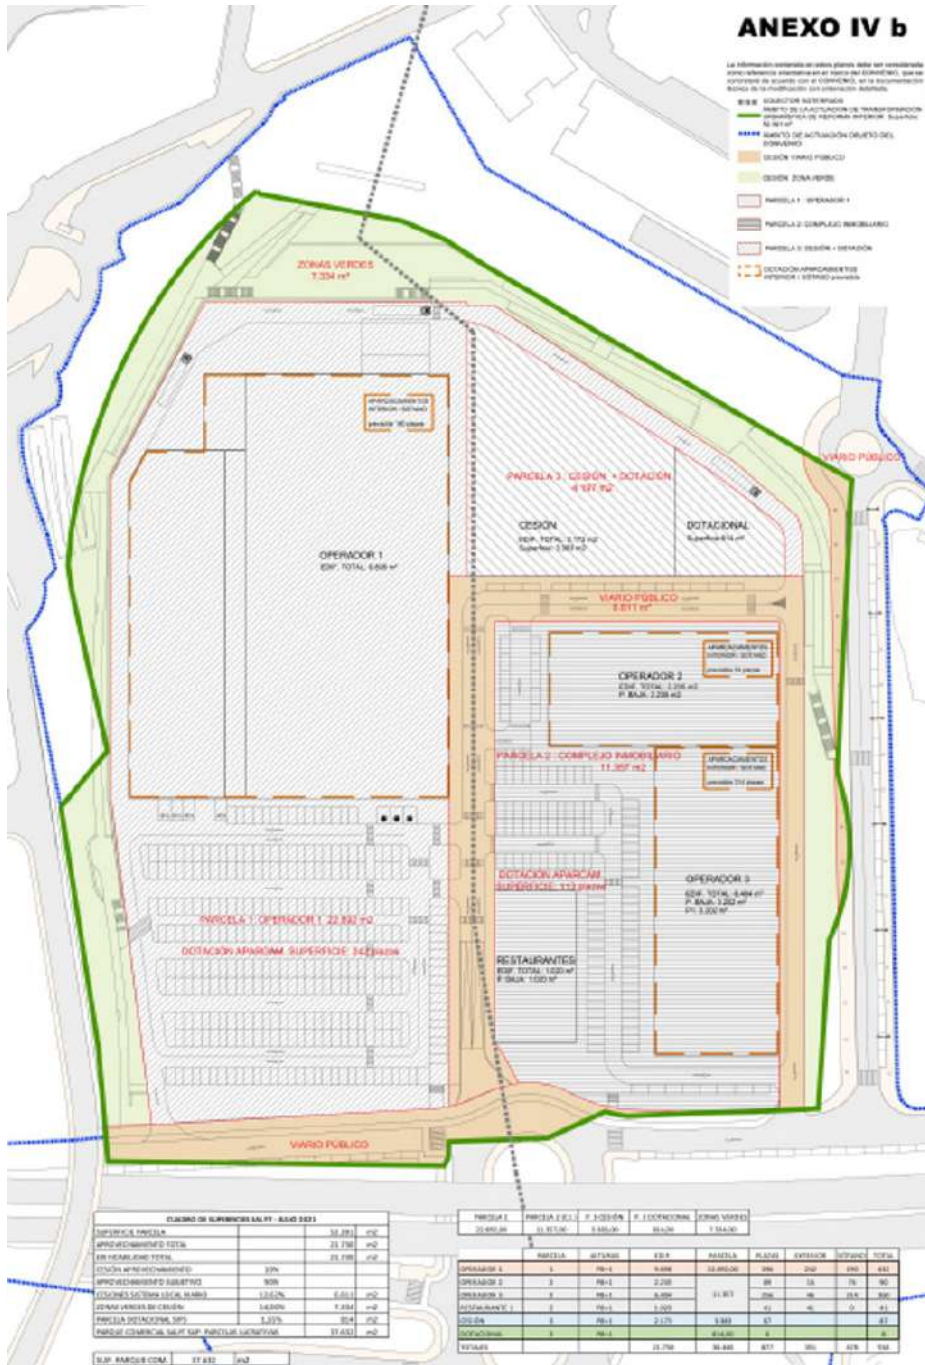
\_PLANIMETRÍA ANEXO IVb DEL CONVENIO\_ORDENACIÓN INDICATIVA\_TEJAR DE SALYT
